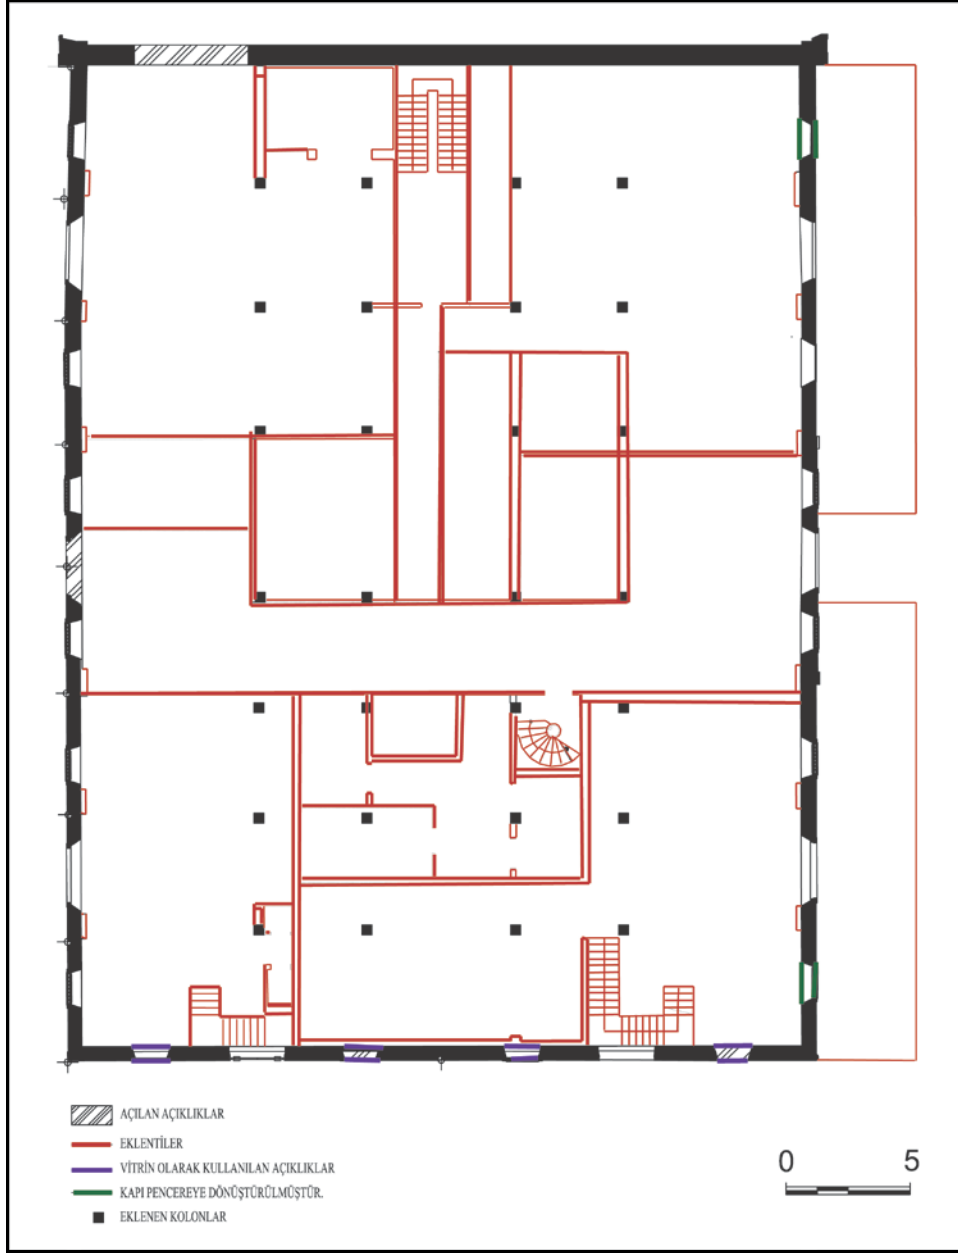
II. Dönem Karakol Filo Binası Plan Şeması
